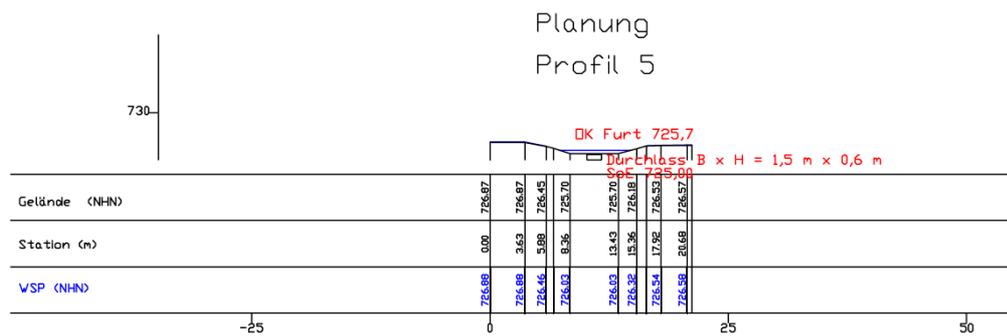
Planung - mit Furt und Durchlass (vgl. Anlage P)
